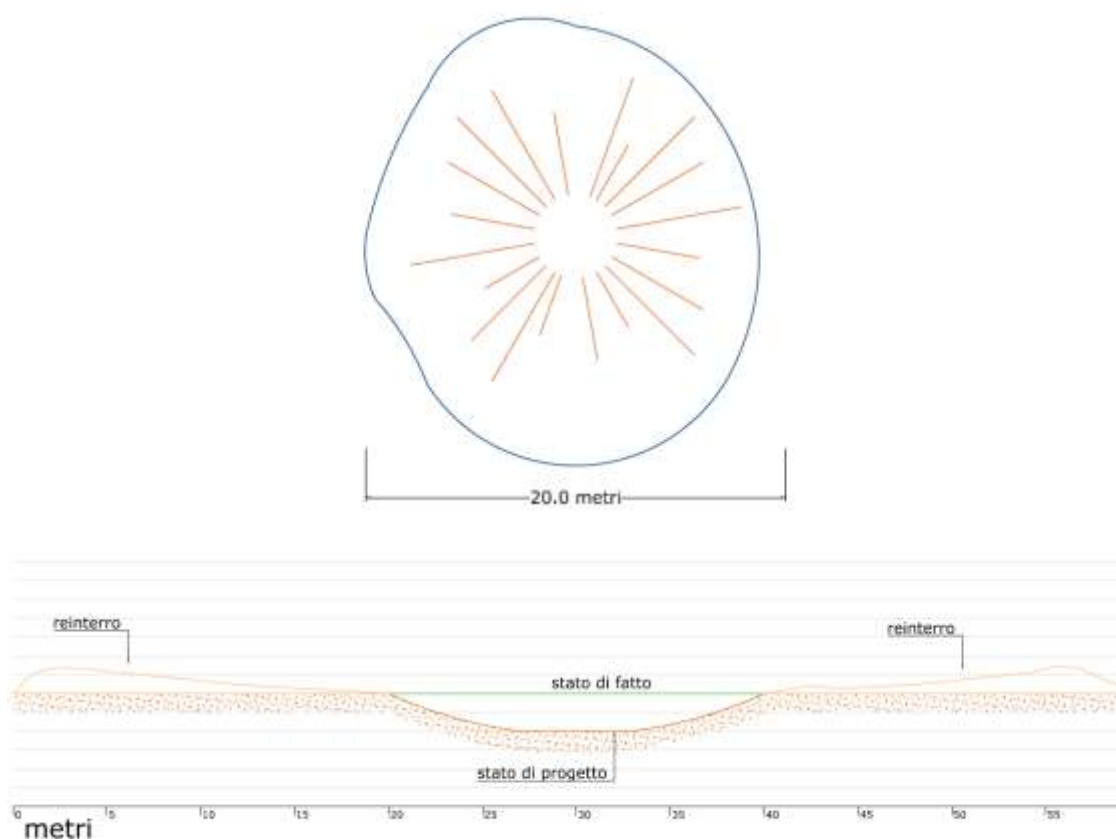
SCHEMA CARATTERISTICO (PIANTA E SEZIONE) DI POZZA TEMPORANEA.
